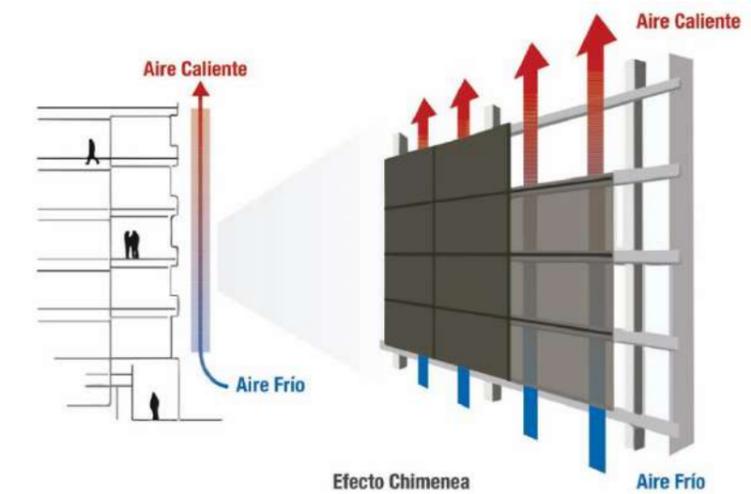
Fachada ventilada. Tomado de [www.a5fachadas.com](http://www.a5fachadas.com).
